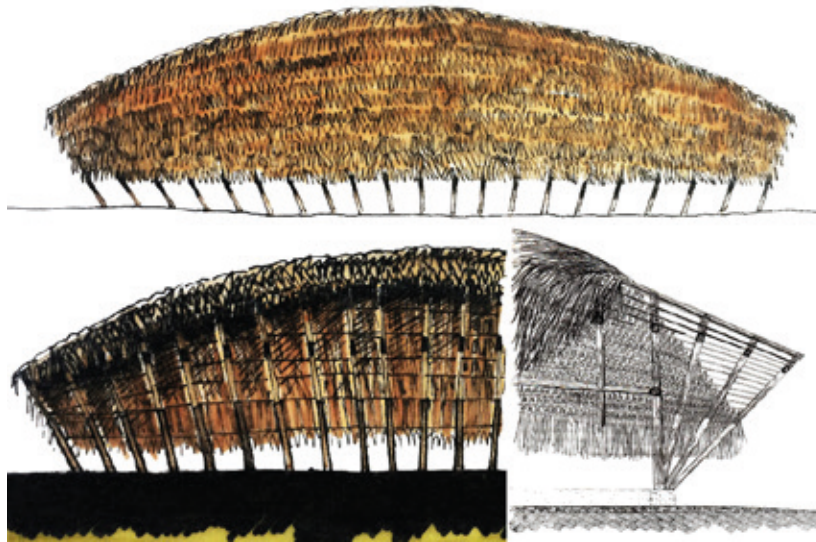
Casa en Apulo, Fachada oriente, fachada norte.
